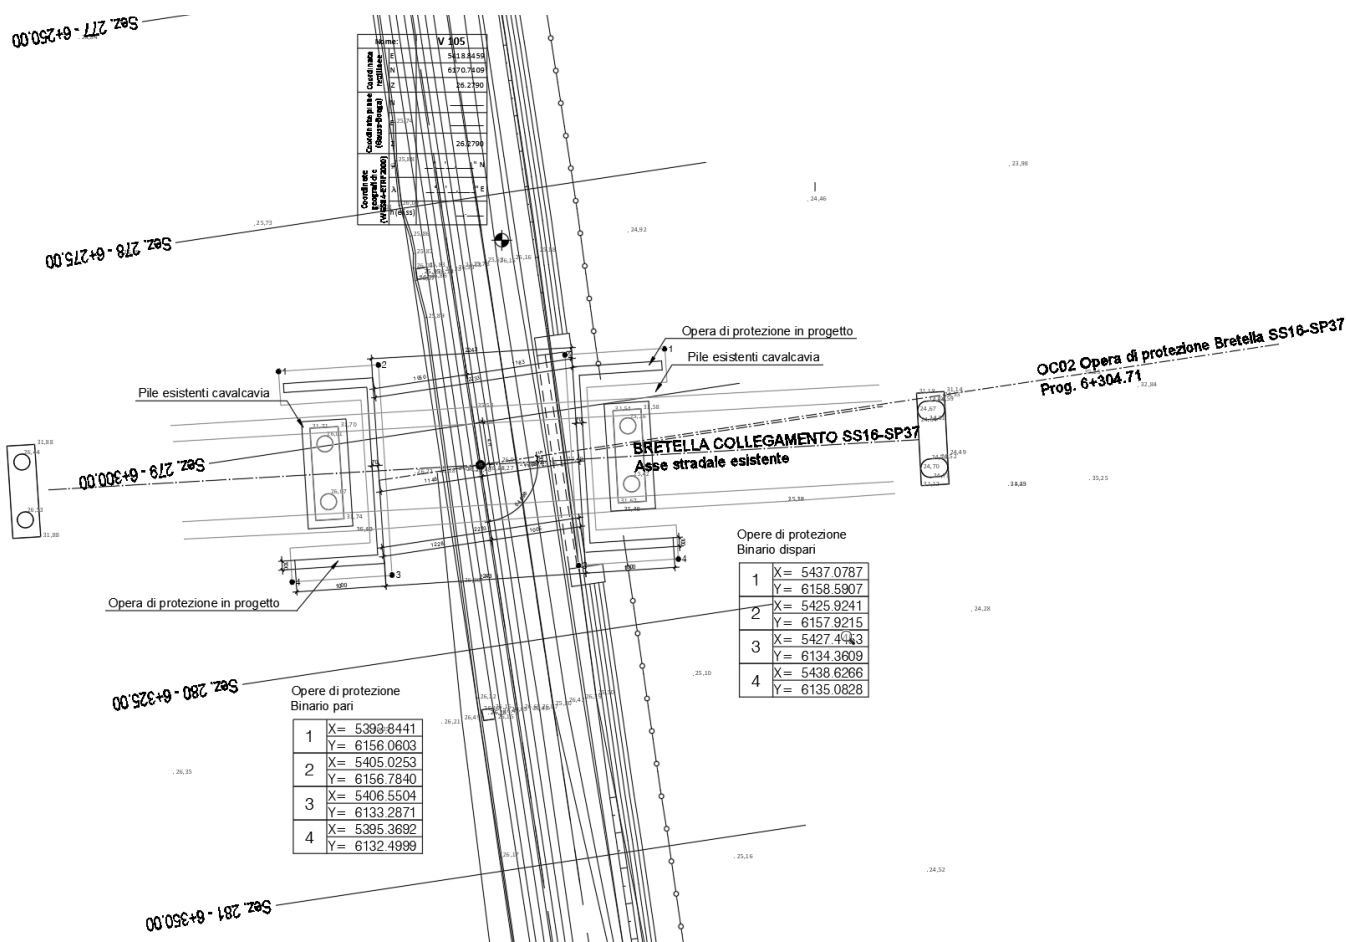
Opere di protezione pile SS16-SP31 – Stralcio planimetrico
